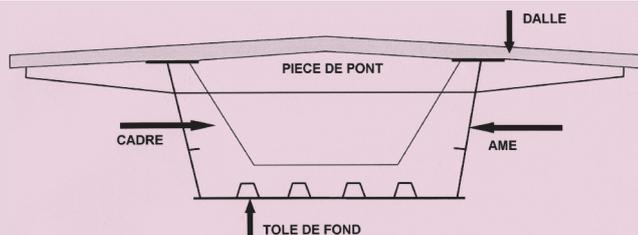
Caisson à pièces de pont avec consoles (cas d'une chaussée à dévers en toit)
